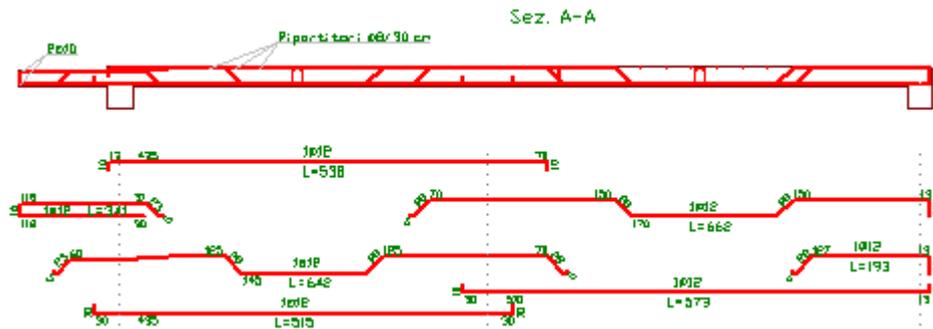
Sezione longitudinale del travetto e distinta armatura.
